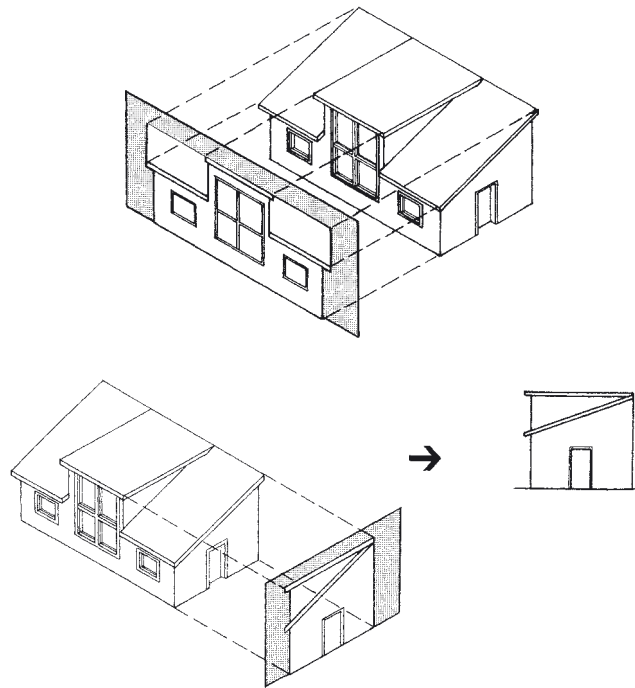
Prospetto frontale e laterale di un edificio.
